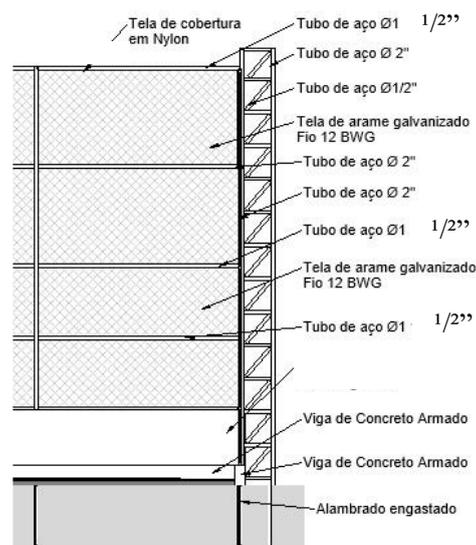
Detalhe de instalação do alambrado (Fonte: Autor/2024)
